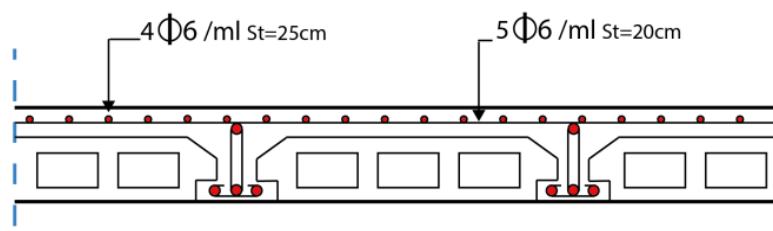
Schéma de ferrailage de la dalle de compression.
